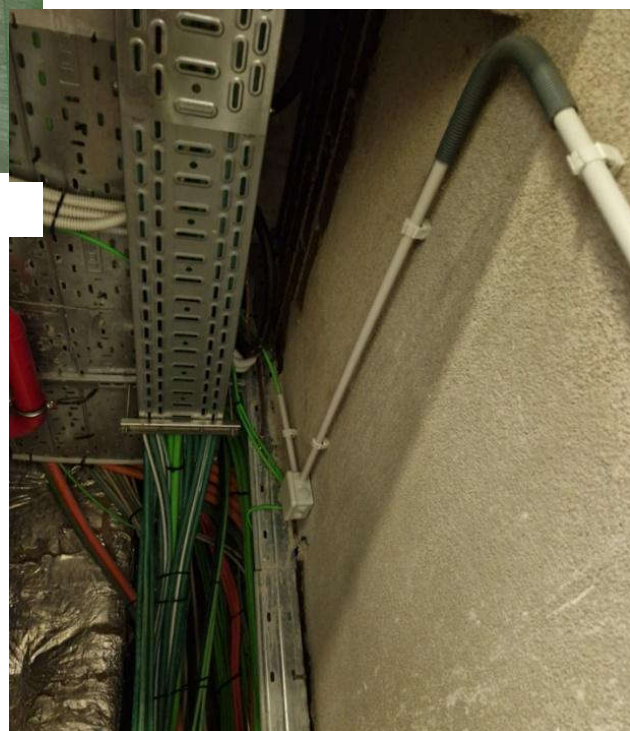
Canalitzacions a utilitzar per a pas de cablejat
